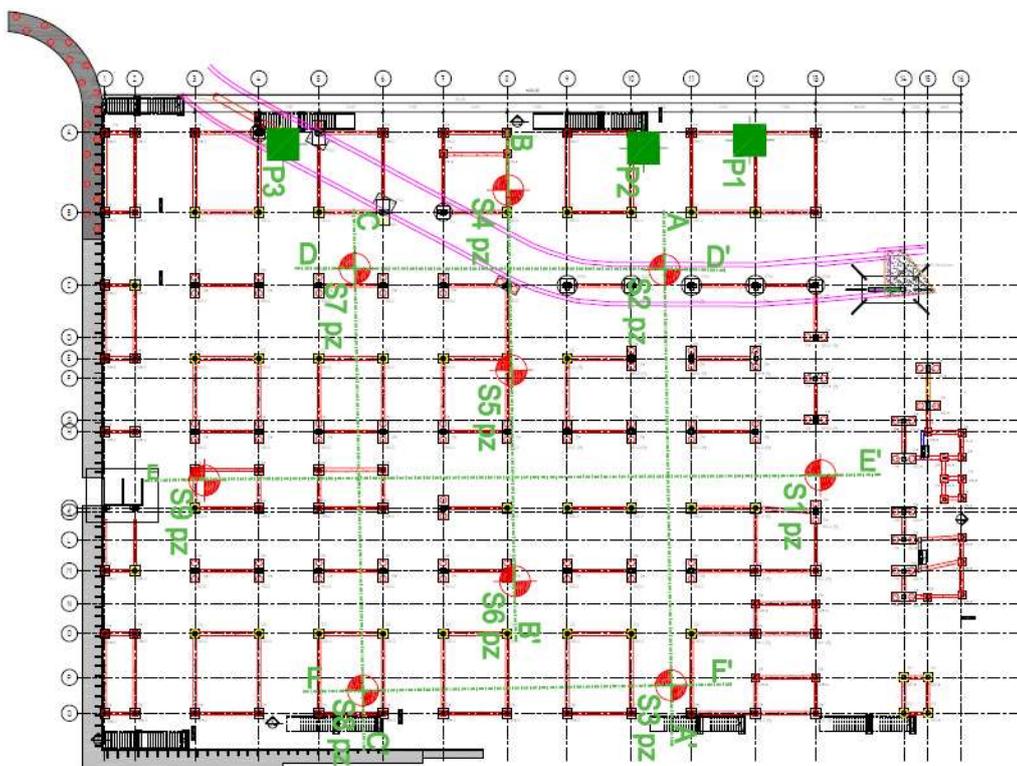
Sobreposição do projeto geotécnico com a planta de implantação de estacas –
